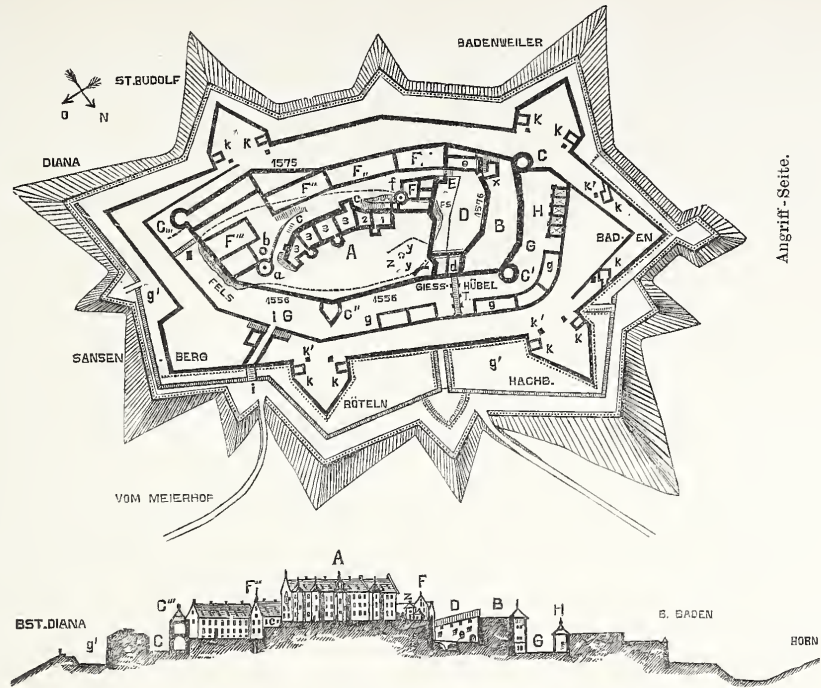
u. 73. Lageplan und Längenschnitt der Festung Hachberg 1: 3000.
